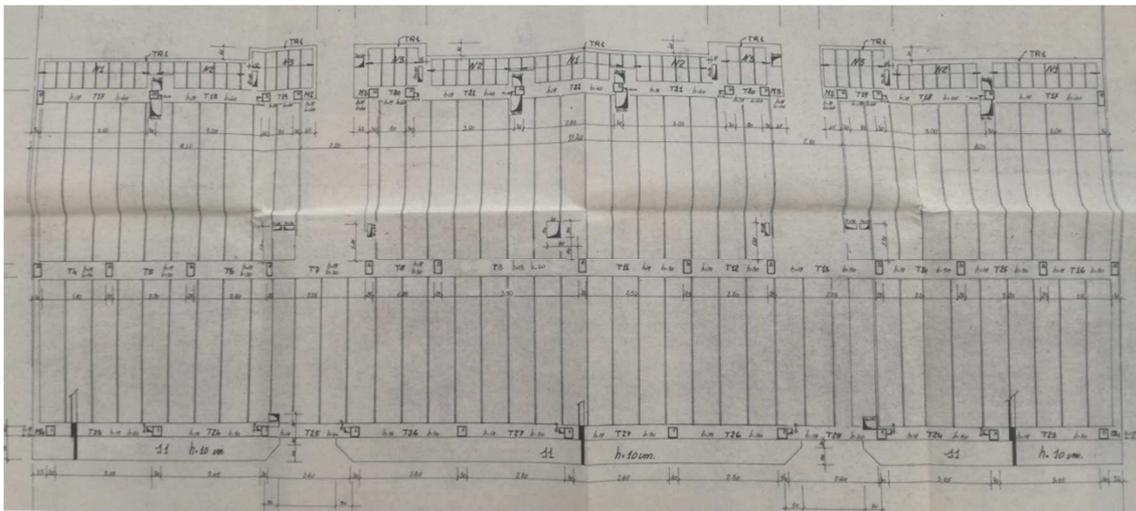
Estratto carpenteria solaio tipo condominio in via Sobrero 6/8
